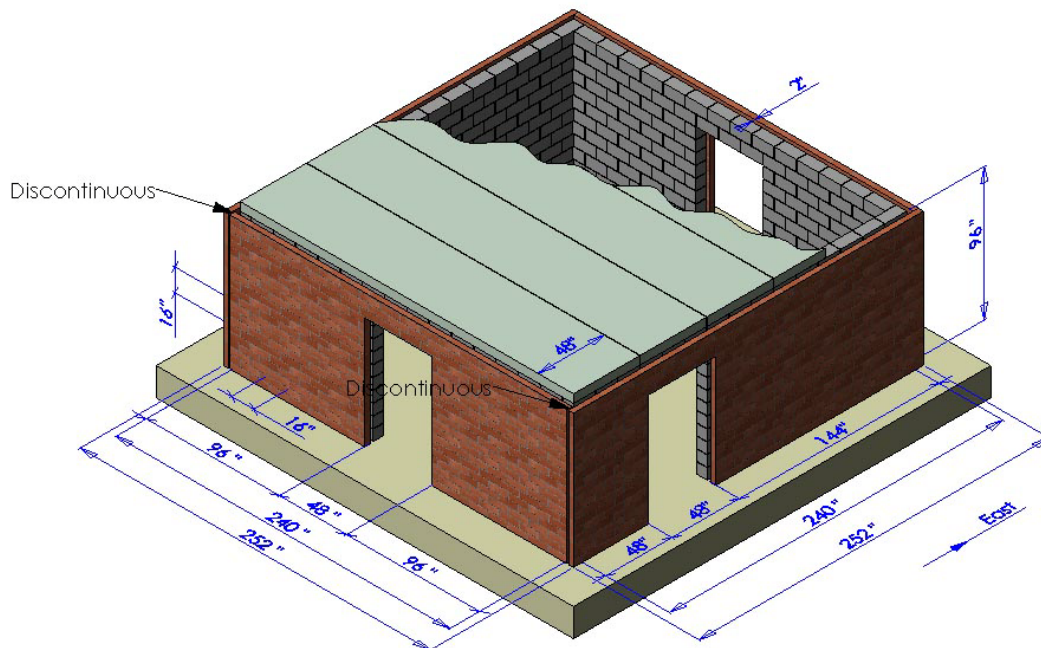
Estructura prototípica de mampostería de concreto y fachadas de mampostería de arcilla
